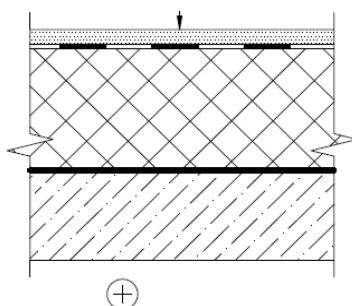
Классическая эксплуатируемая кровля с покрытием для пешеходных зон из армированной цементно-песчаной стяжки
